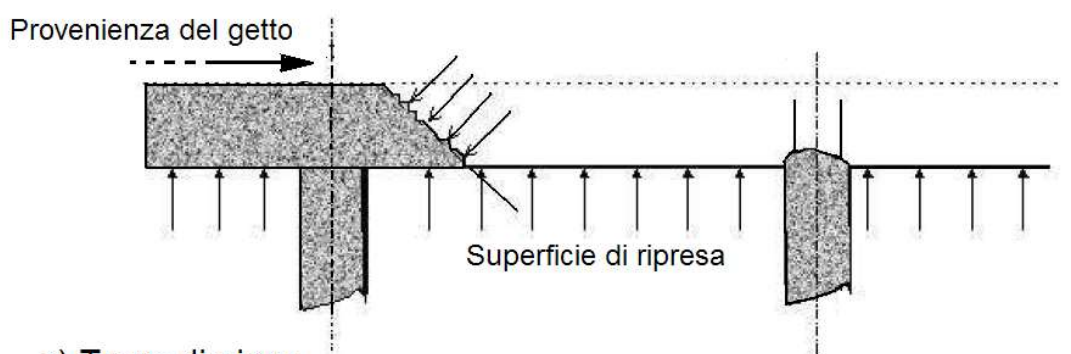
Modalità di ripresa del getto in travi di piano e di fondazione
